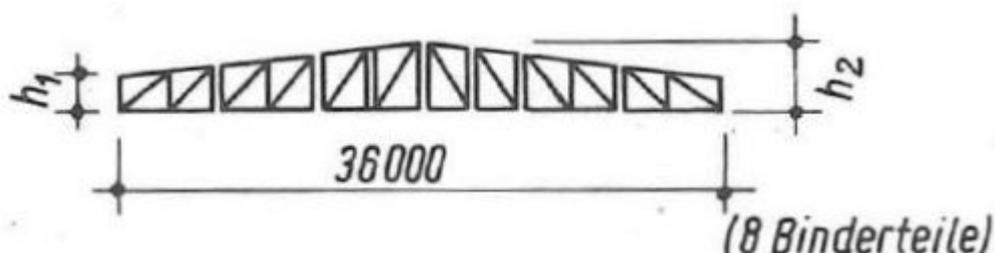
8-teiliger Spannbeton-Fachwerkbinder (Satteldach), [1], aus Bild 127
